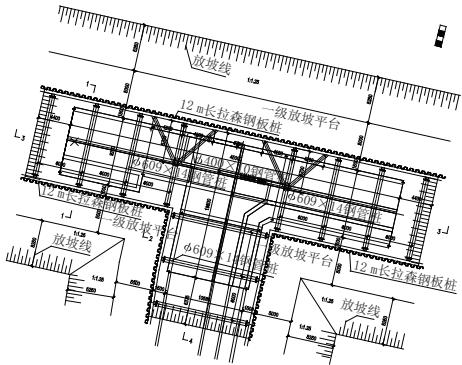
放坡开挖 + 钢板桩支护平面图(单位:mm)
